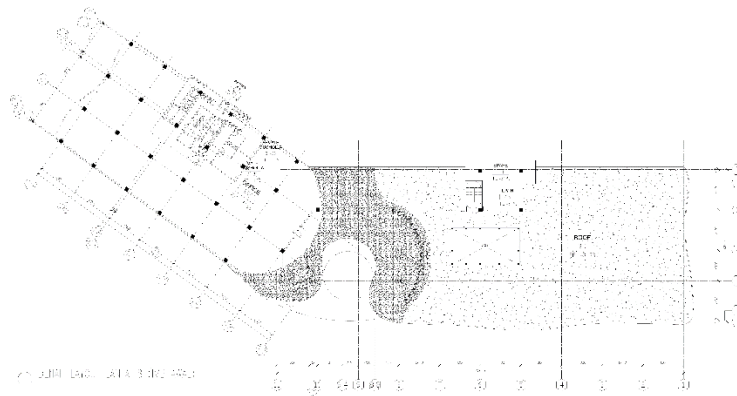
Denah Lantai 6 Spazio, (Dokumen Badan Pengelola Bangunan Spazio, 2015)
